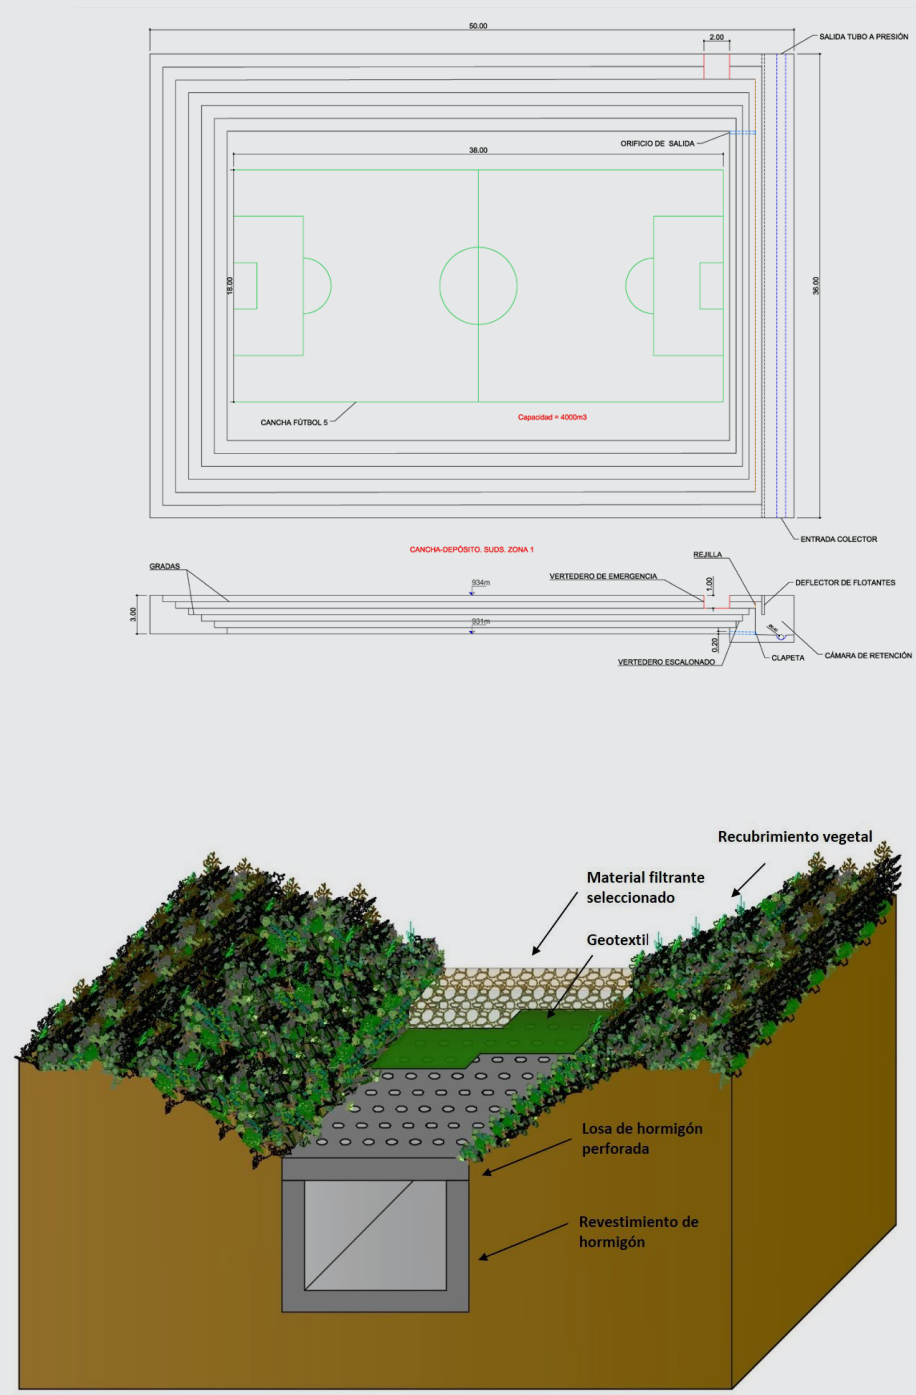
| Detalle cancha deportiva- deposito. Zona 1 (arriba). Sección tipo para la zanja drenante (abajo).
